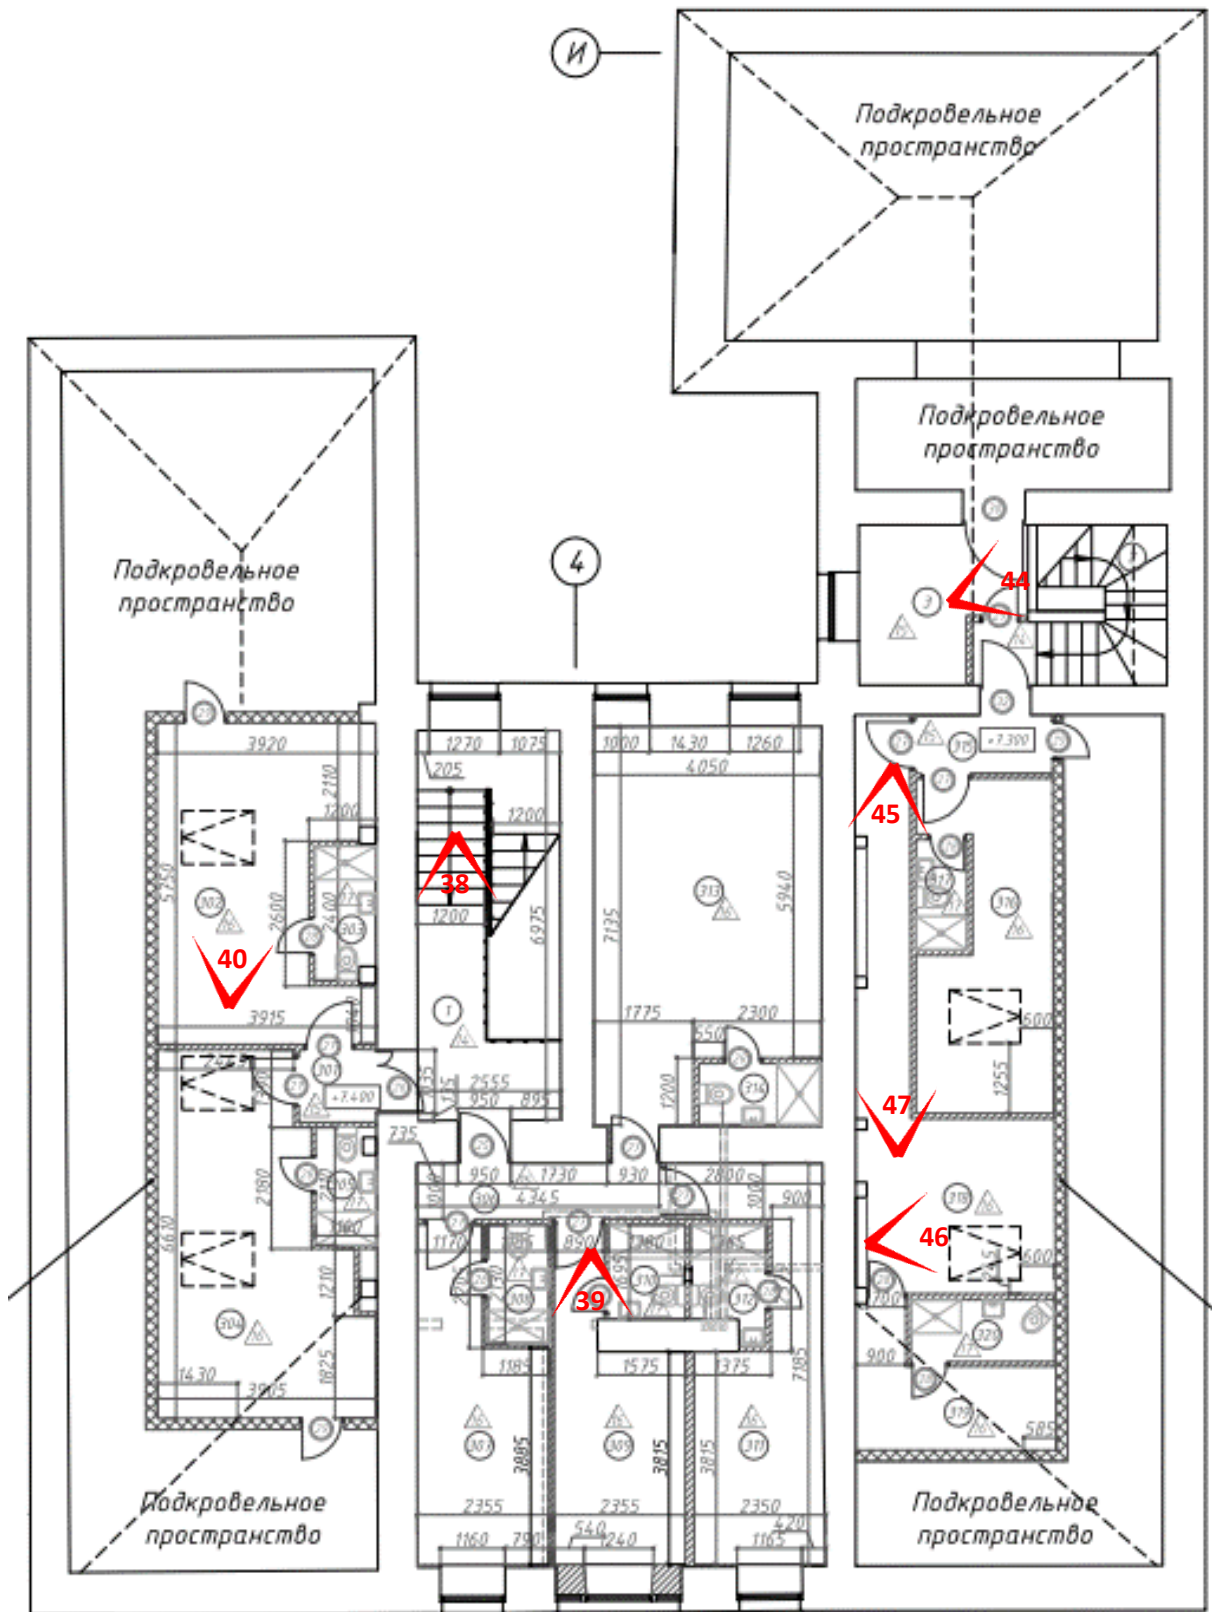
Схема фотофиксации на плане помещений, 3 этаж
